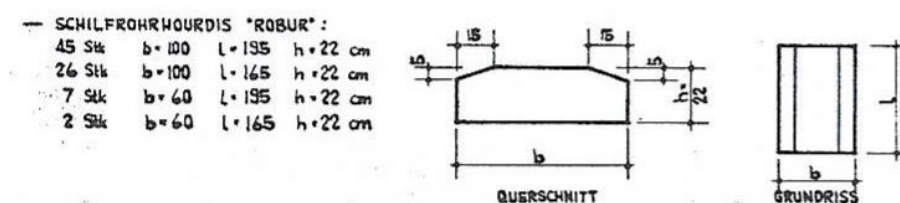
Auszug aus dem Schalungsplan der Decke EG: Darstellung Hohlkörper (Hourdis)
